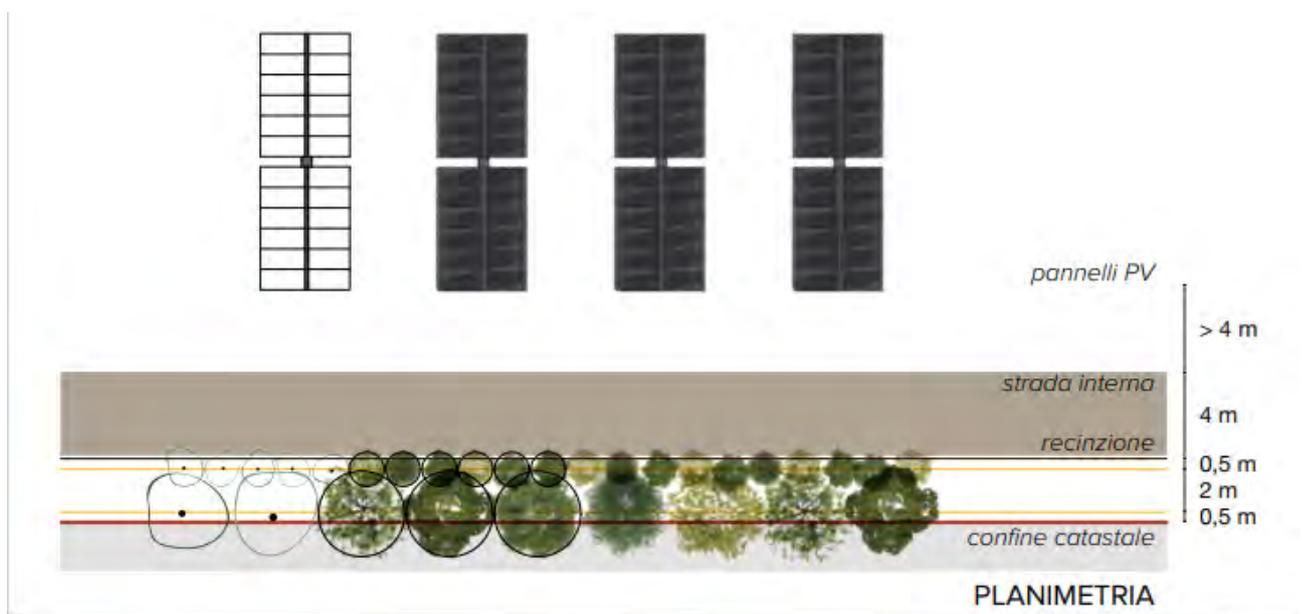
a. Fascia vegetata a due file parallele sfalsate prevista dal progetto
